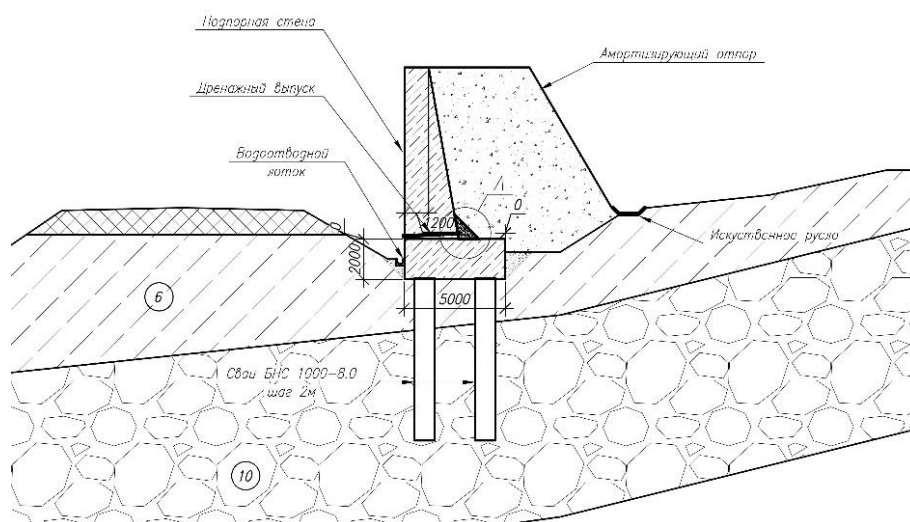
Дамба в виде подпорной стены на свайном основании с грунтовым отпором. Разрез
